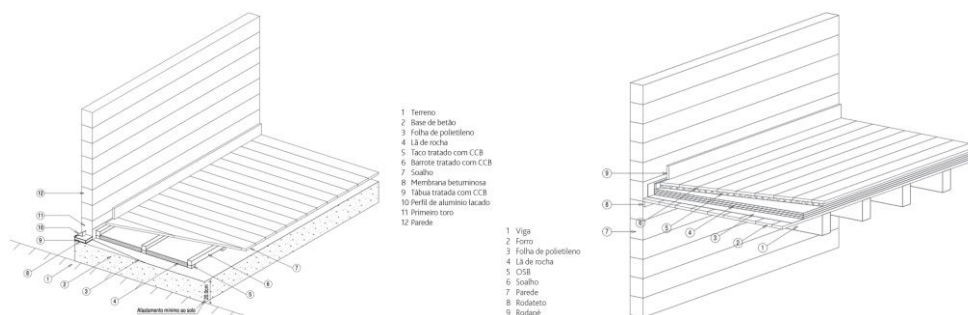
Pavimento térreo e pavimento elevado no sistema Rusticasa (LNEC, 2012).
